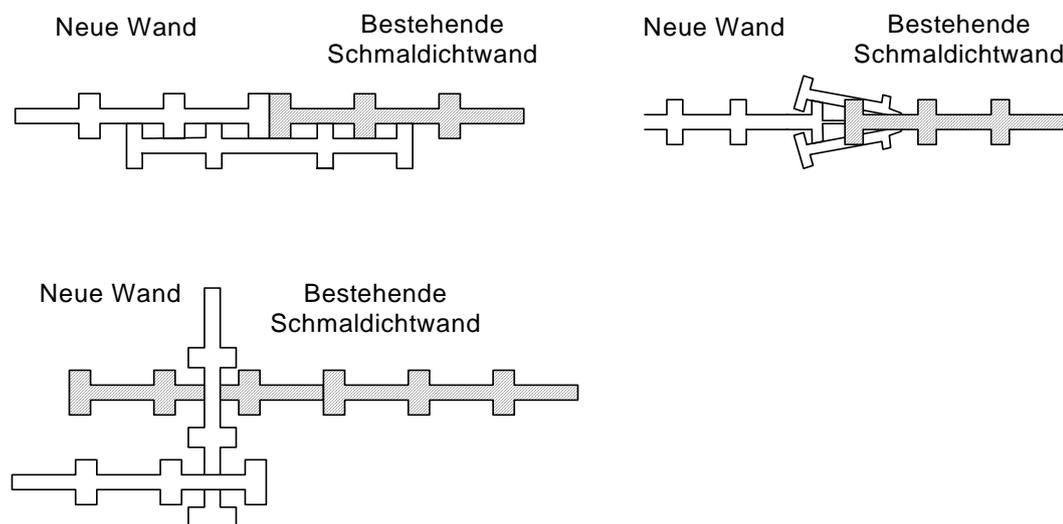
Mögliche Anschlüsse von neuen an bestehende Dichtwände [1]
